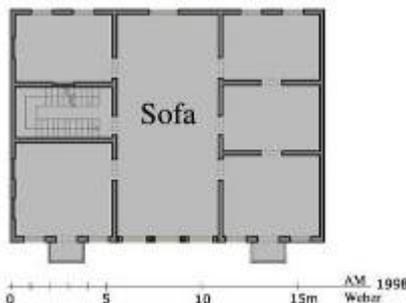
Bayt Ġabrī [988], Grundriss OG
